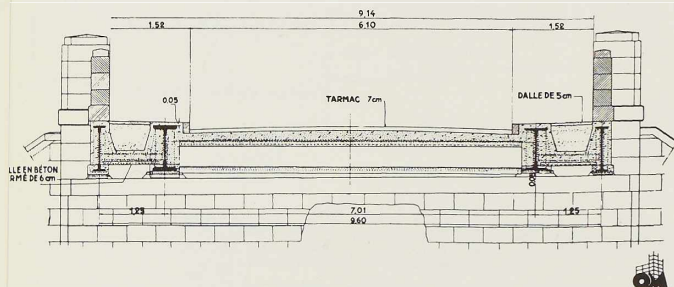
Coupe transversale montrant la disposition des poutres sous les trottoirs.
